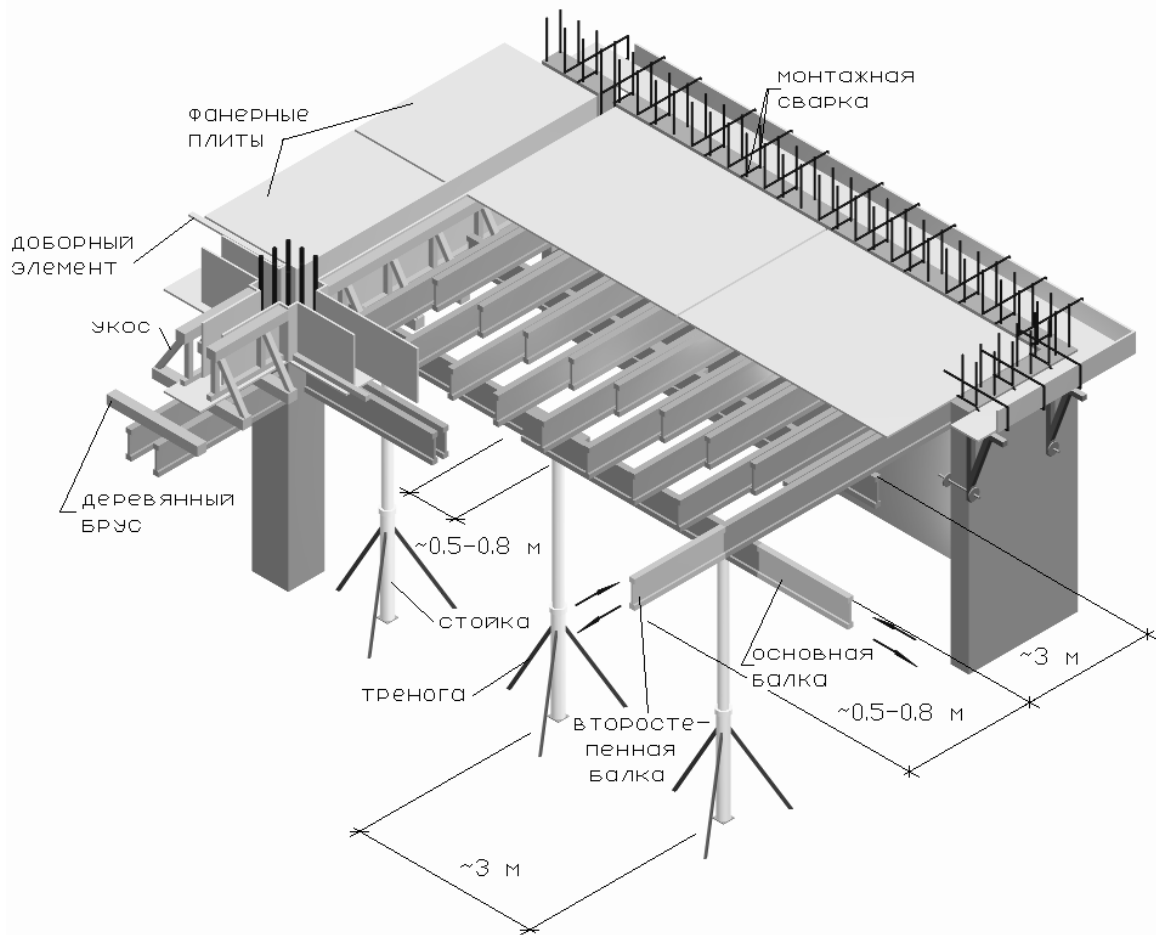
Устройство опалубки фирмы «Дока» при бетонировании перекрытий.
